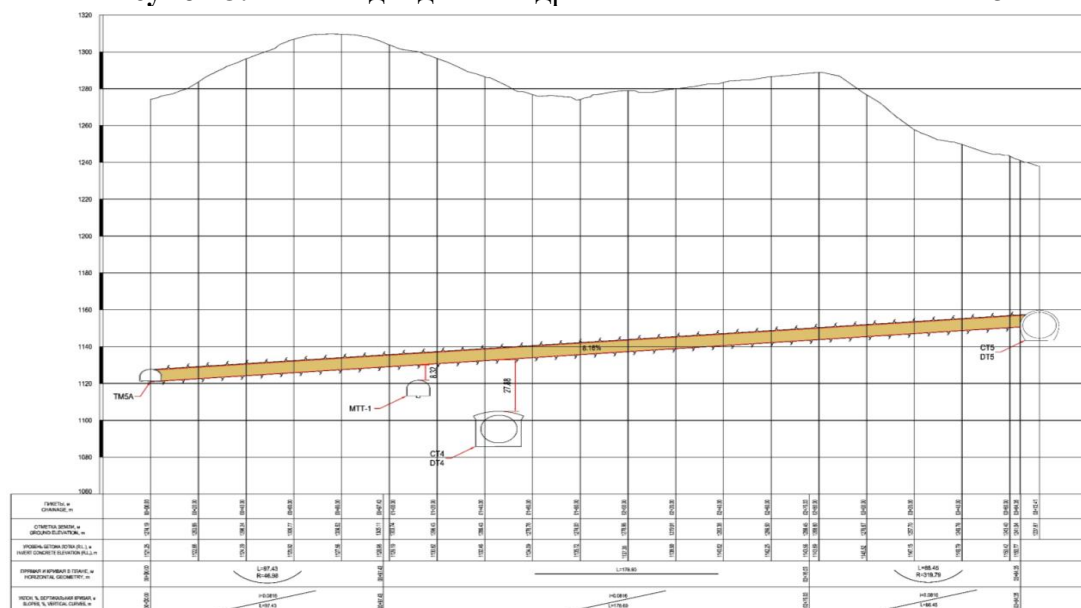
Продольный разрез гидротехнического тоннеля САСТ-5
